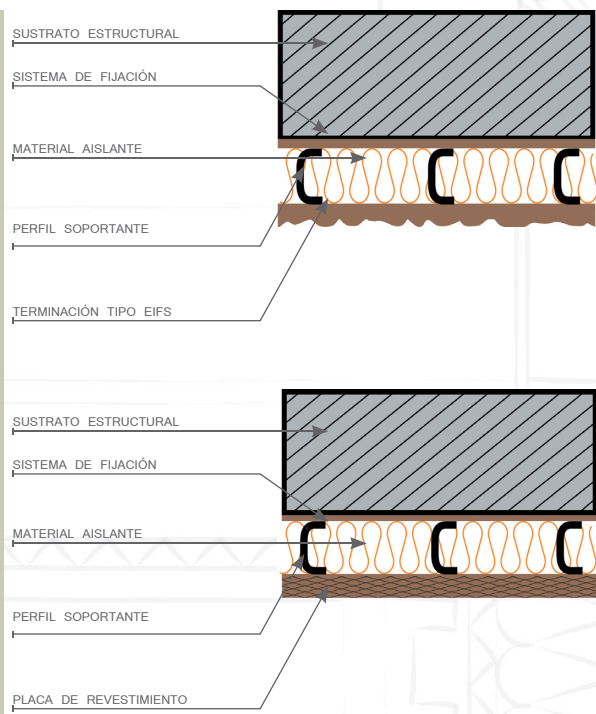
v: Esquema de solución FNV-PC con estructura metálica y plancha de EPS (vistas corte horizontal).
